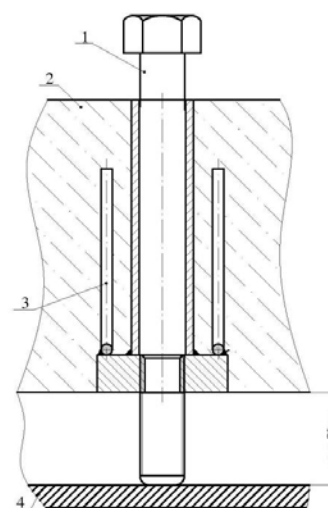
Регулюючий пристрій для установки плит БМП:
